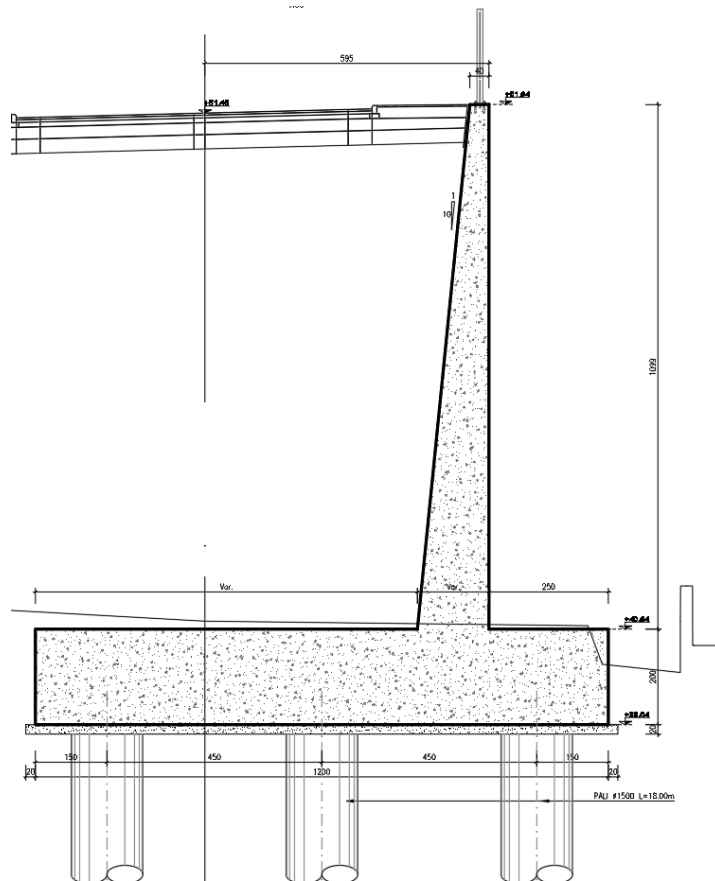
Sezione trasversale muro lato spalla A in dx
